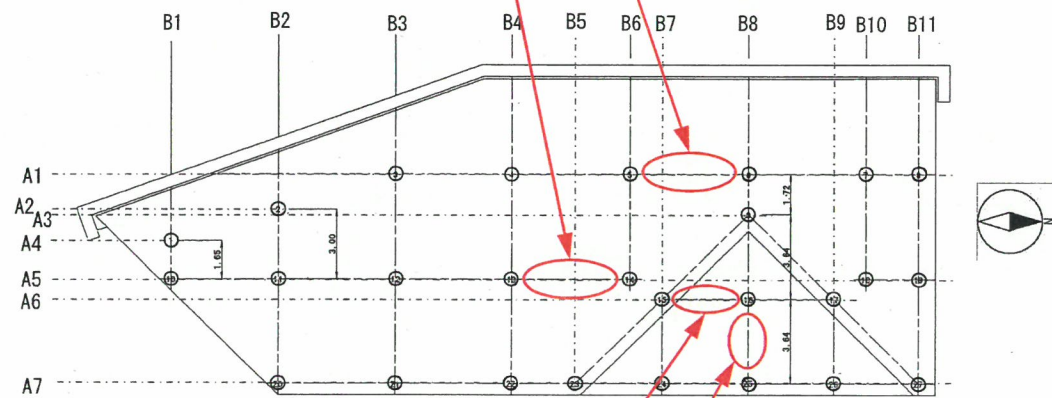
搬出入施設・車両乗降部 平面図 (下部工: 海水面より上)
